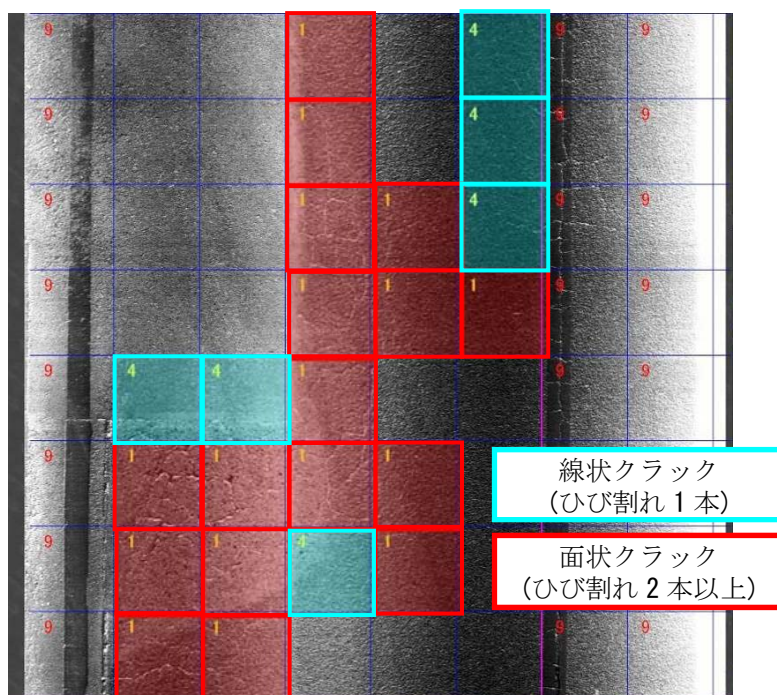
ひび割れ解説例 (メッシュ法)
